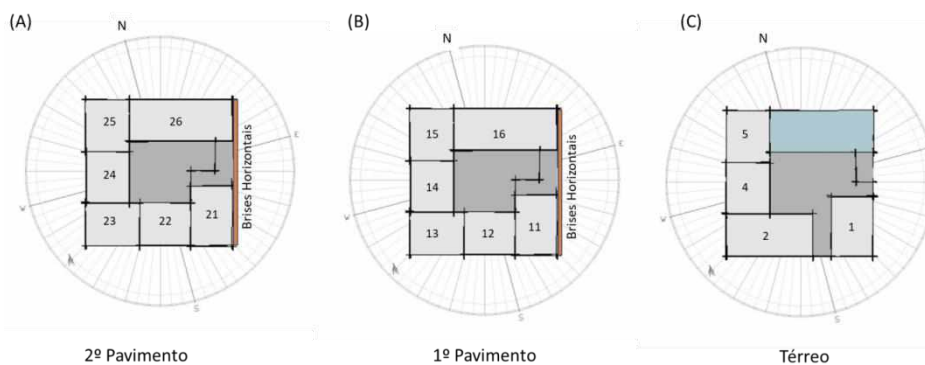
Identificação das Salas que serão objeto de estudo - (A) Nomenclatura das salas do 2º Pavimento, (B) Nomenclatura das salas do 1º Pavimento, (C) Nomenclatura das salas Pavimento Térreo.
